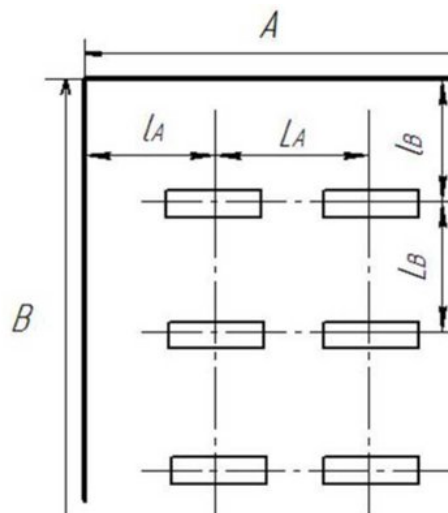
Фрагмент план помещения при освещении газоразрядными светильниками.
